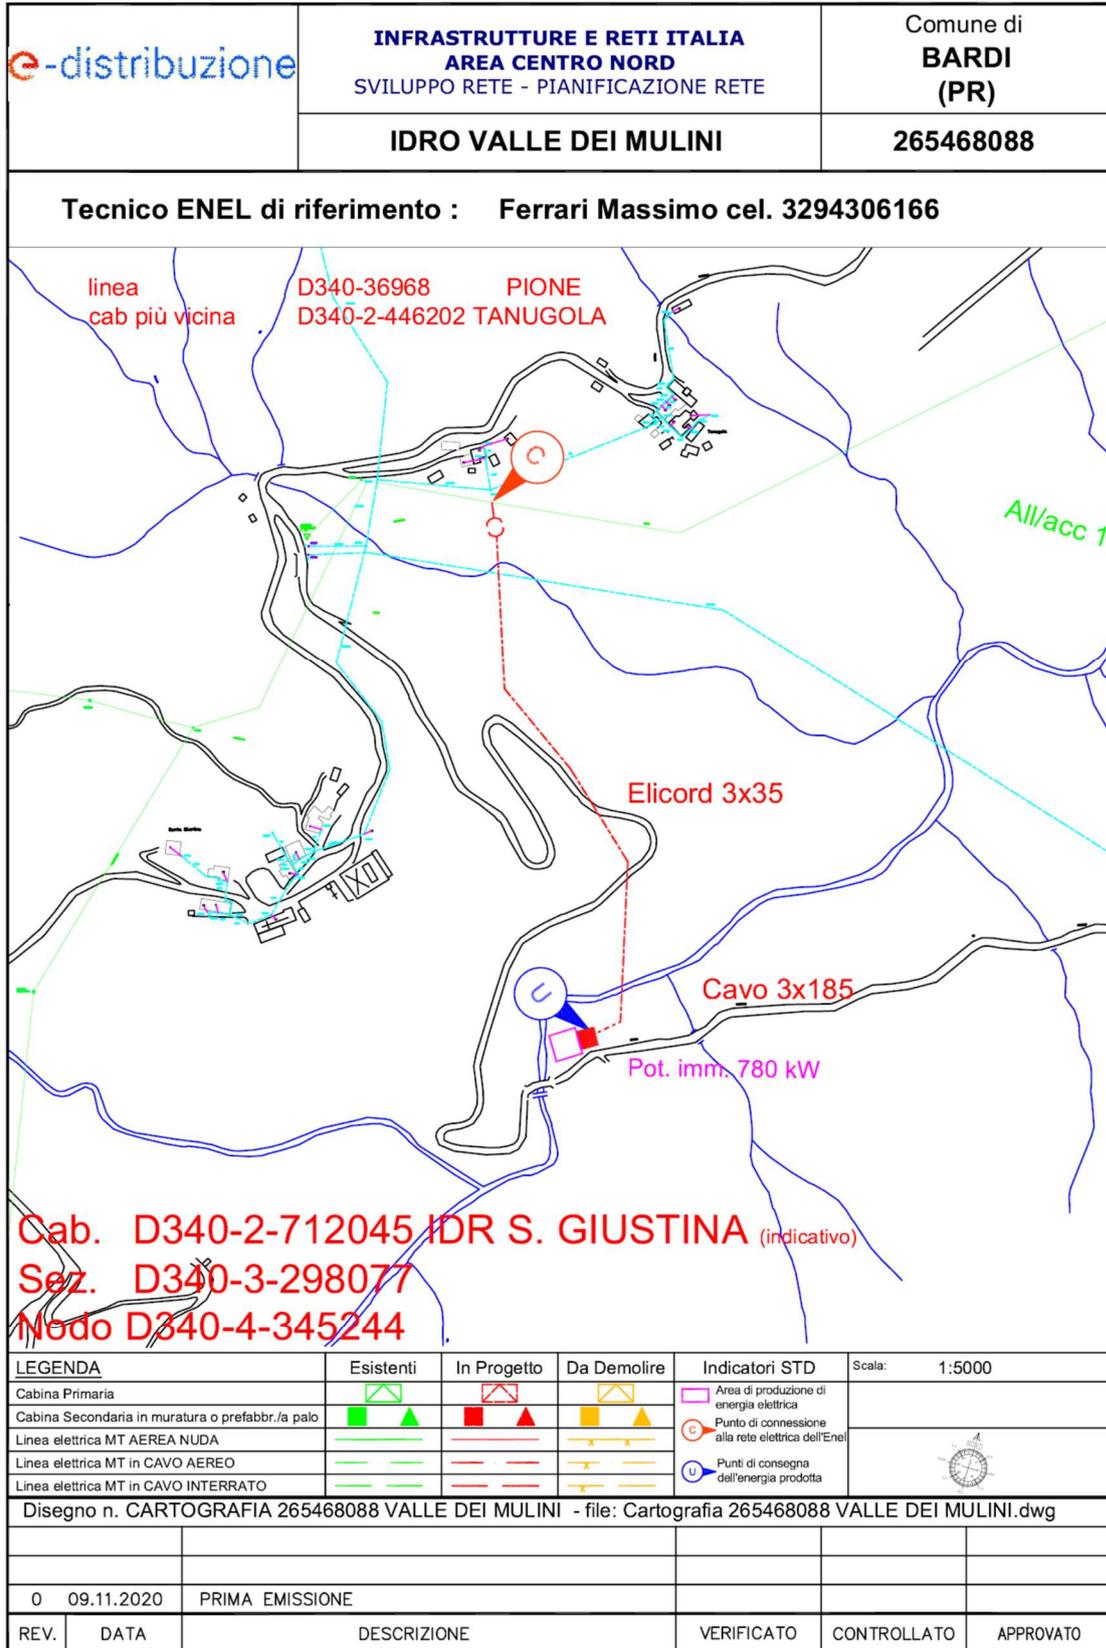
Estratto planimetrico progetto di massima preventivo di connessione.
